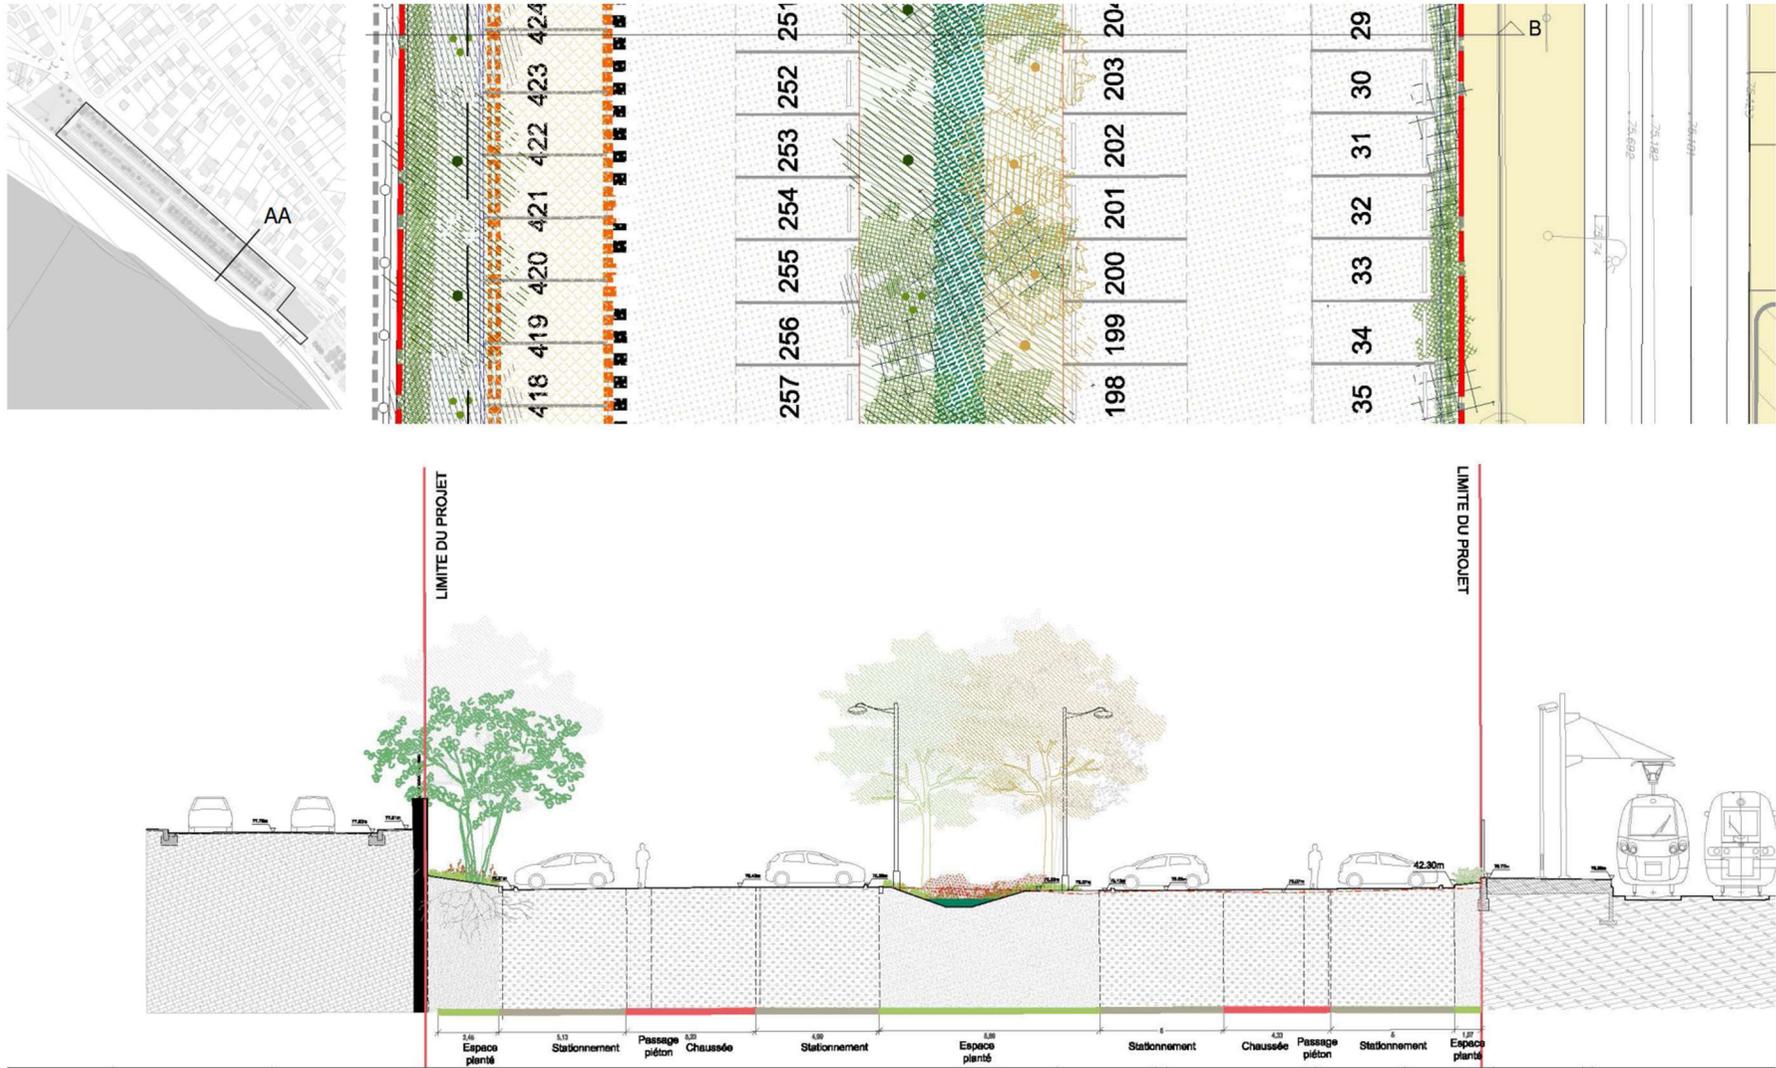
Coupe (AA) du futur parking (AREP Territoires, PRO)
